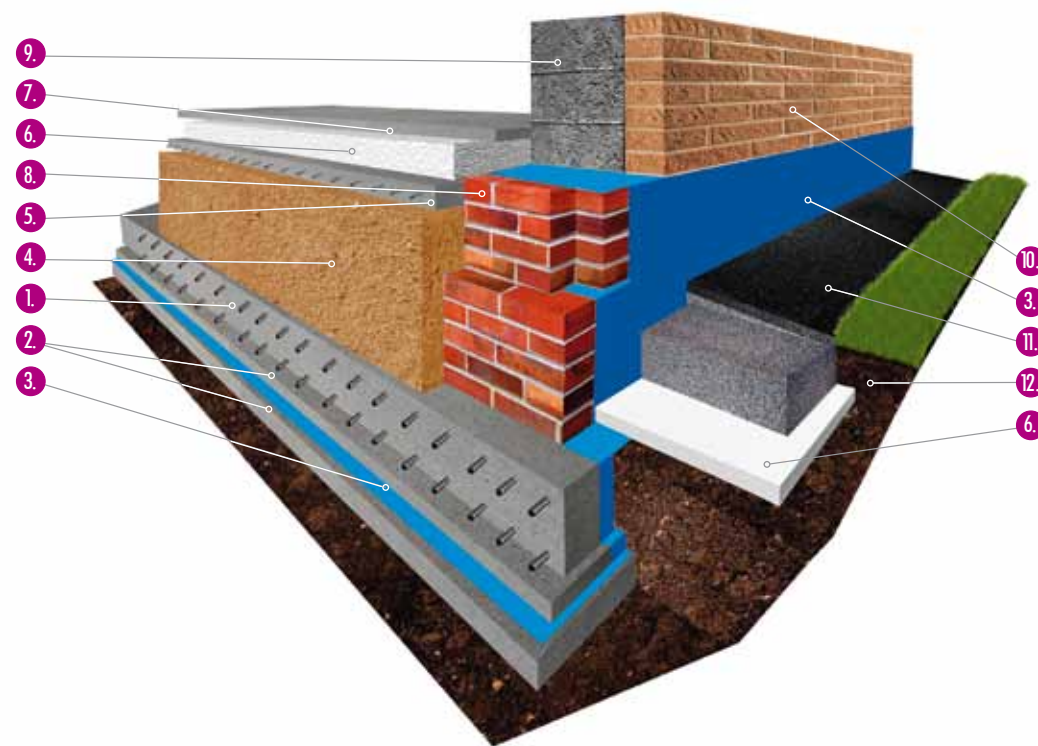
Утепление плитного фундамента пенополистирольными плитами KNAUF Therm®Floor и KNAUF Therm®5 in 1 F:
